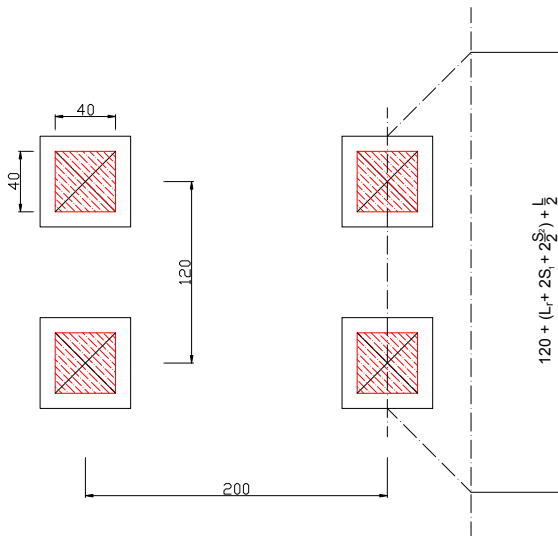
Diffusione su sezioni tipiche mezzeria e pila
